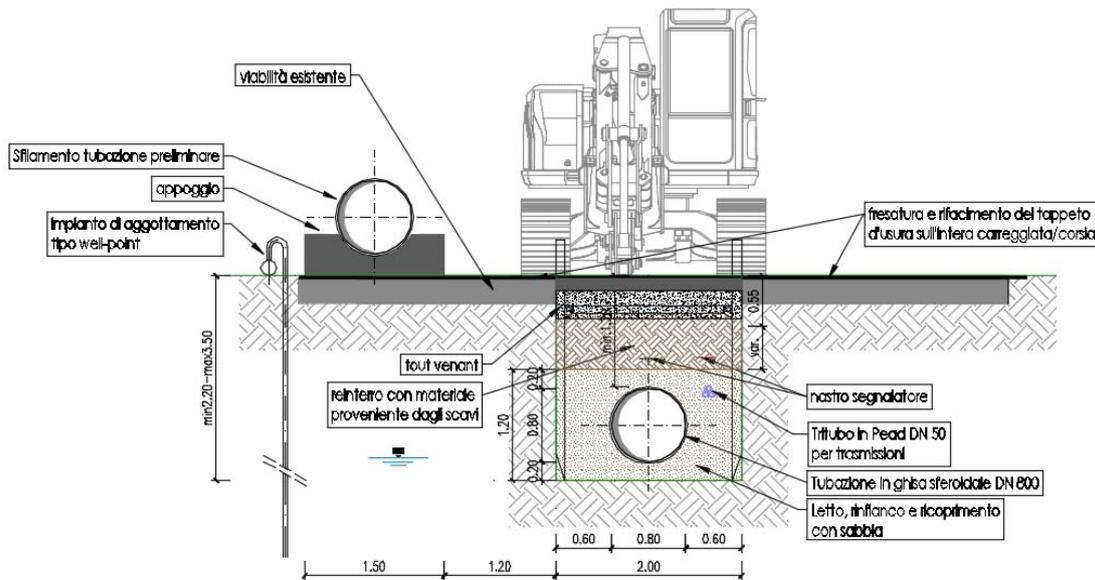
Sezione tipo 3 di scavo e di posa su strada comunale
